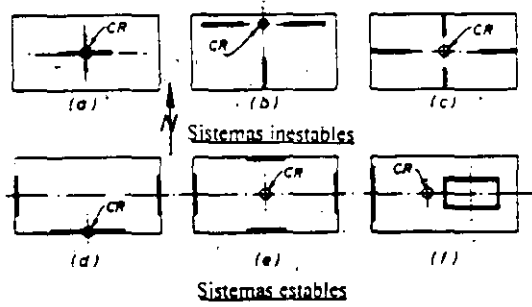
Ejemplos de estabilidad torsional en sistemas de muros estructurales
